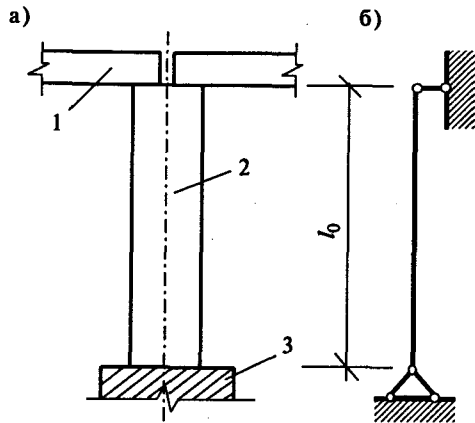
Соединение кирпичной колонны с балкой и фундаментом: а) конструктивная схема столба; б) расчетная схема; 1 — балка; 2 — колонна; 3 — фундамент
